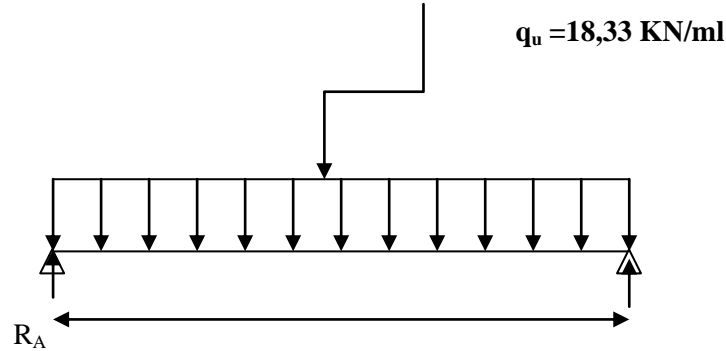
Schéma statique de la poutre palière. ' ELU.
